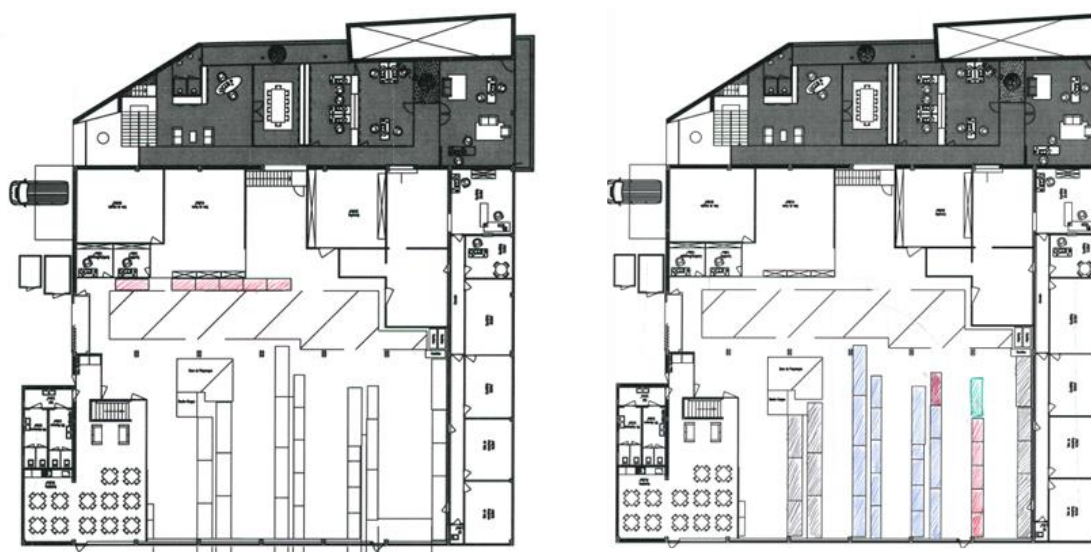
Layouts* do Armazém com uso de Empilhador ou Stacker
